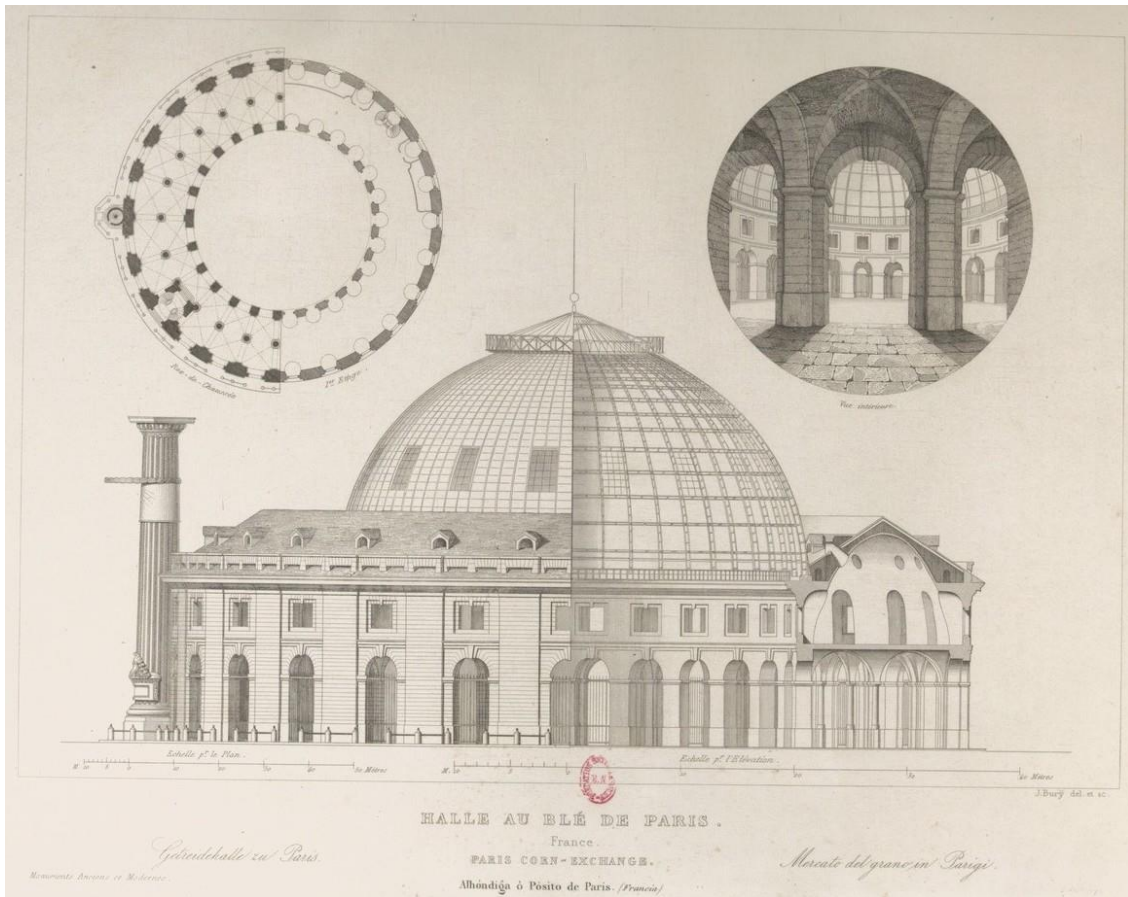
10 : Plan, perspective, coupe-élévation de la Halle au blé avec sa couverture métallique (réalisée en 1809-1813).
